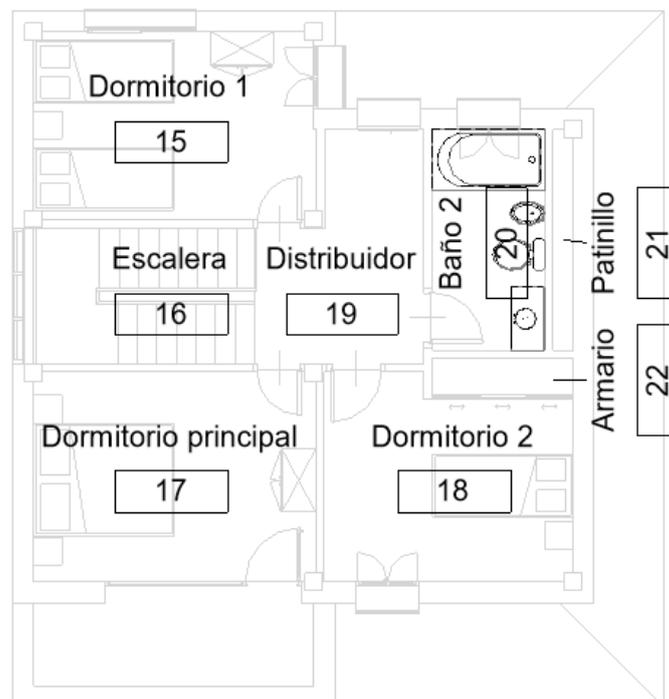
Espacios de planta primera colocados y nombrados. Fuente: propia
